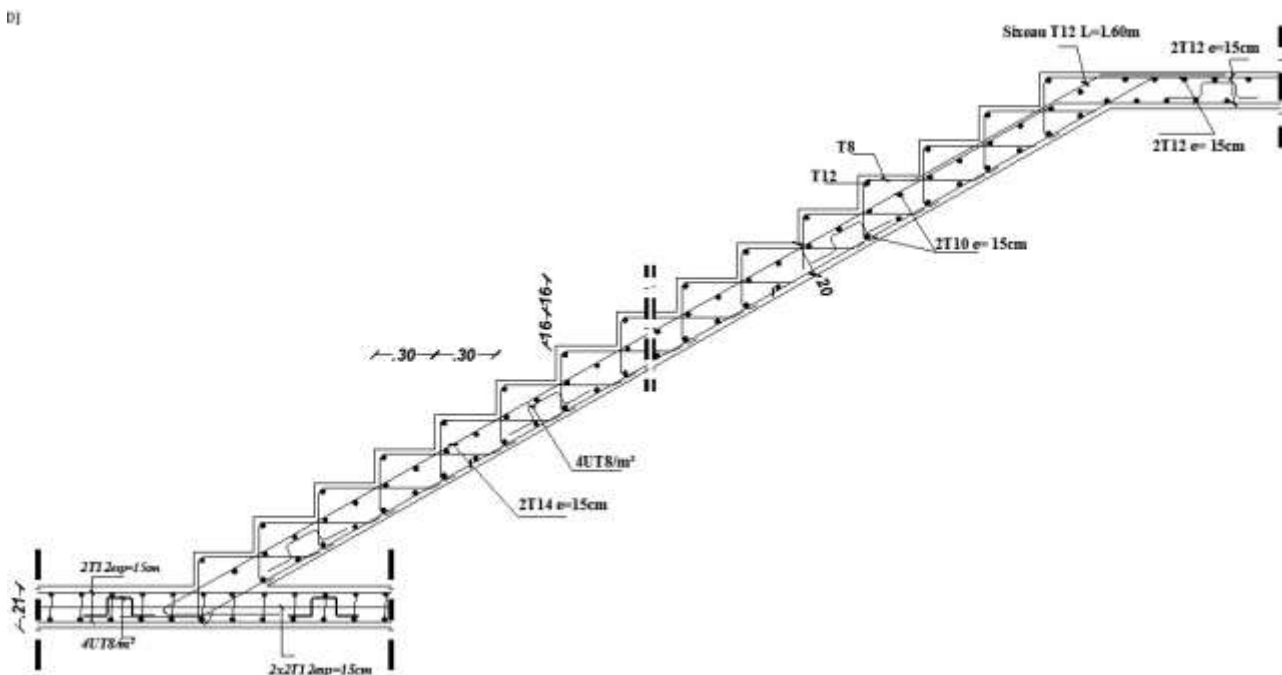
Coffrage et ferrailage de l’escalier type 3
